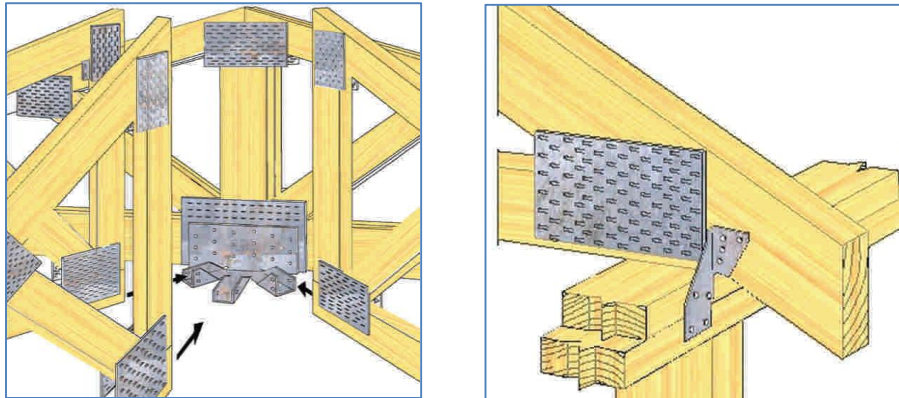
Fijaciones con conectores metálicos en estructura techumbre
